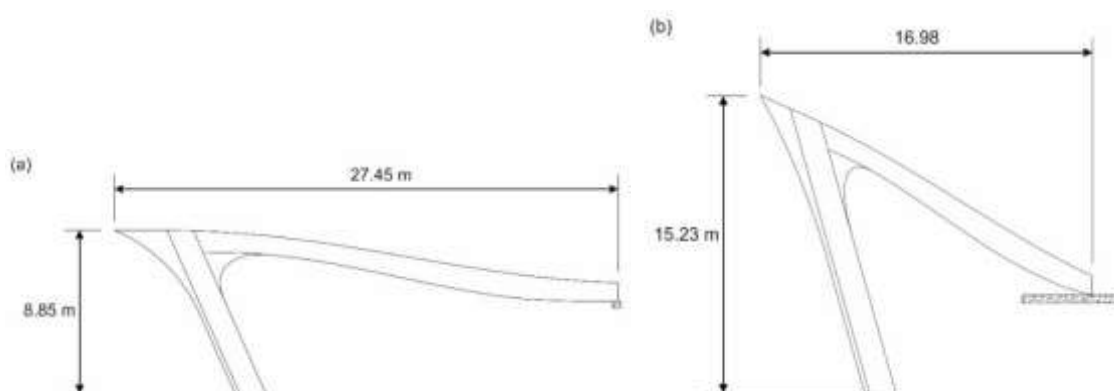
a) Pórtico 13, y b) pórtico 19 (Oak Ingeniería)
